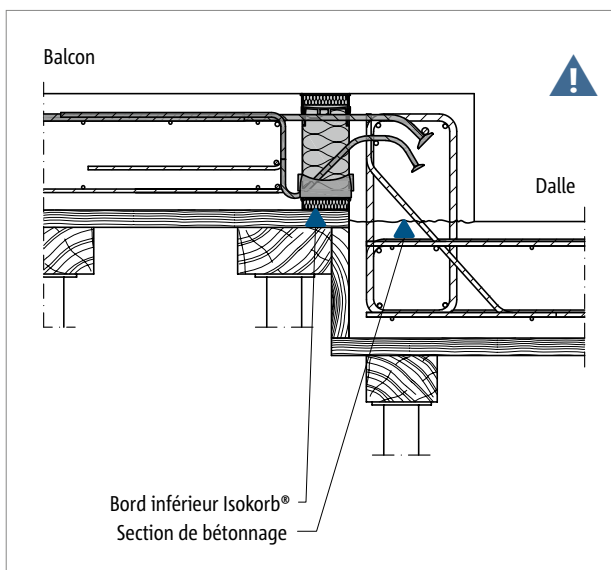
Schöck Isokorb® T type K-O : balcon en béton coulé sur site avec décalage vers le haut
